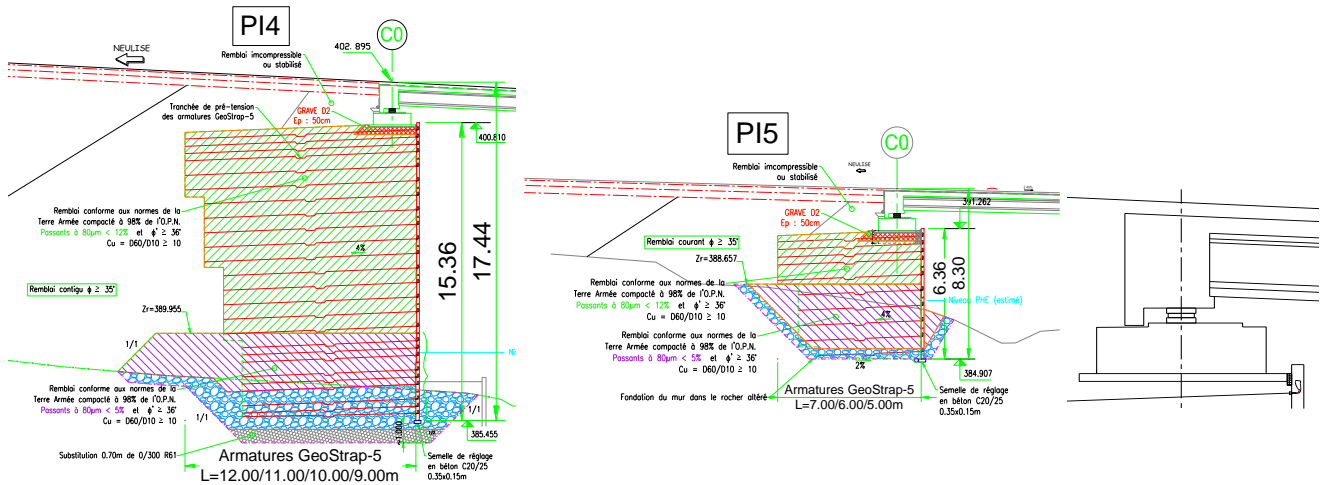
Coupes longitudinales PI4 & PI5 et coupe sur appui du tablier
